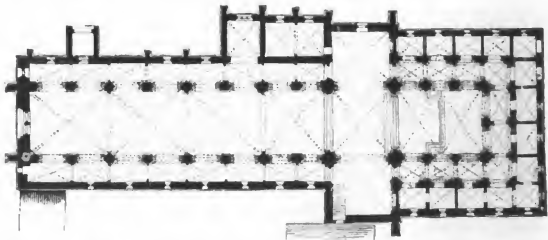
Grundriss der Kirche zu Riddagshausen. (Nach Ahlburg.)
